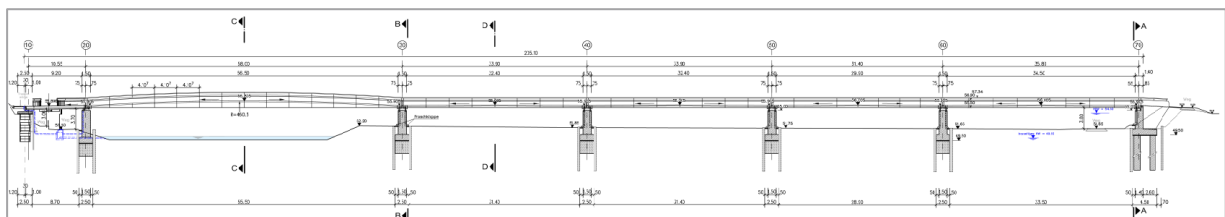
Längsschnitt aus Anlage 04.01 Bauwerkspläne zum Planfeststellungsentswurf, Brücke: Grundriss, Längsschnitt, Ansicht [4]
